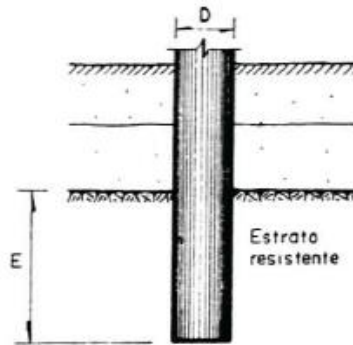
Pilas y pilotes empotrados en el estrato resistente, Manual de diseño y construcción de pilas y pilotes, SMMS, 1983.
